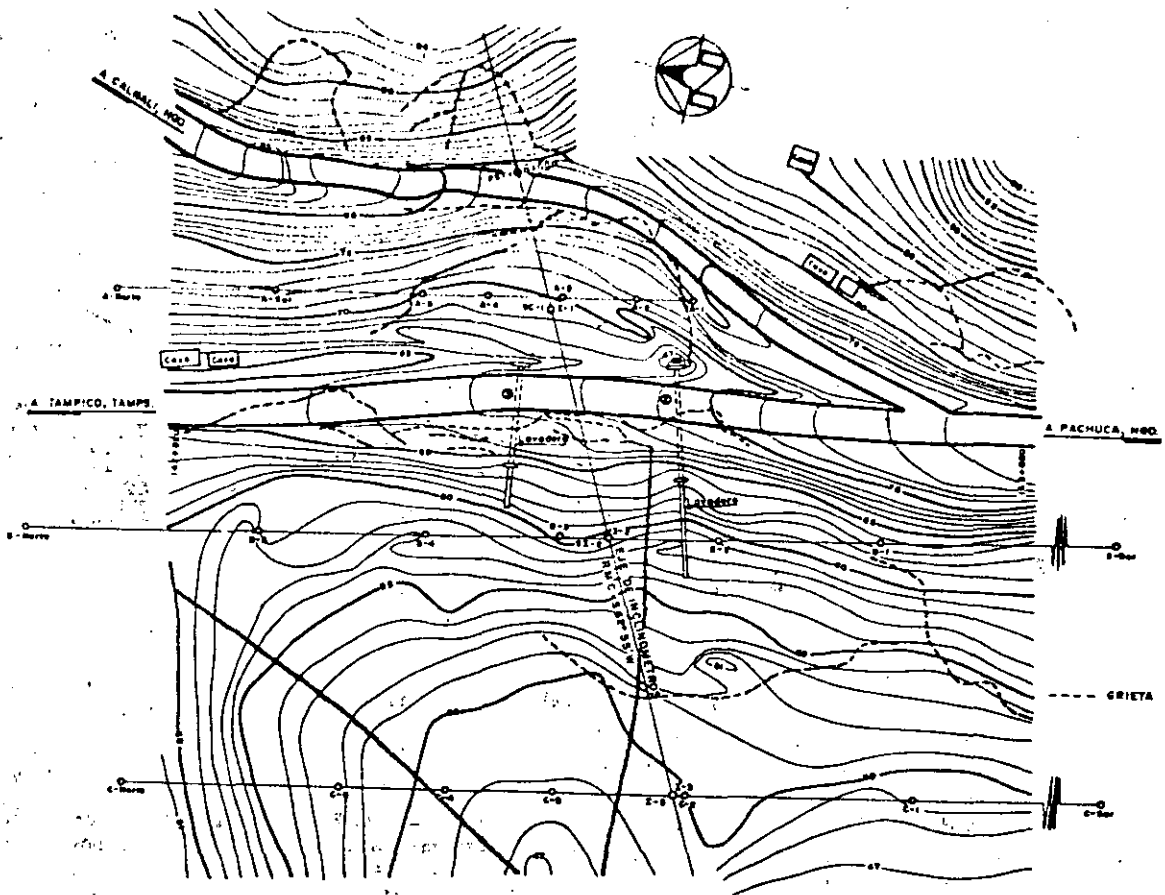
Planta topográfica de la zona de deslizamiento.
